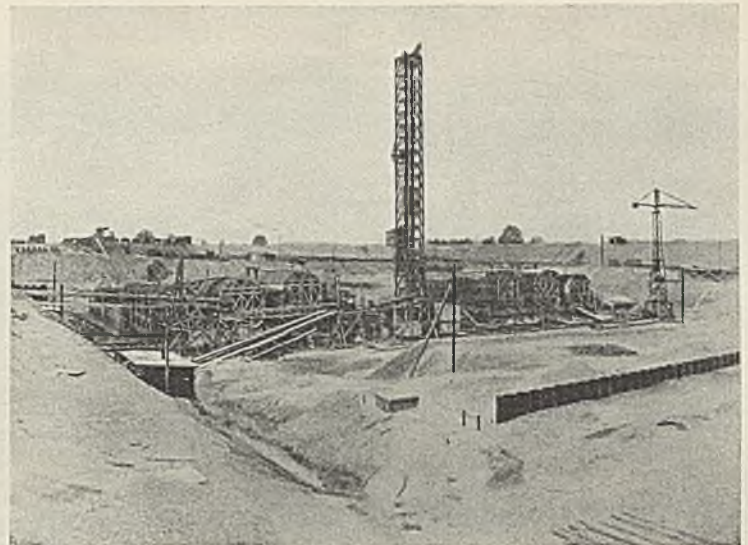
Baustelle für den Grundablaß im Staudamm Ottmachau. Herbst 1929.
